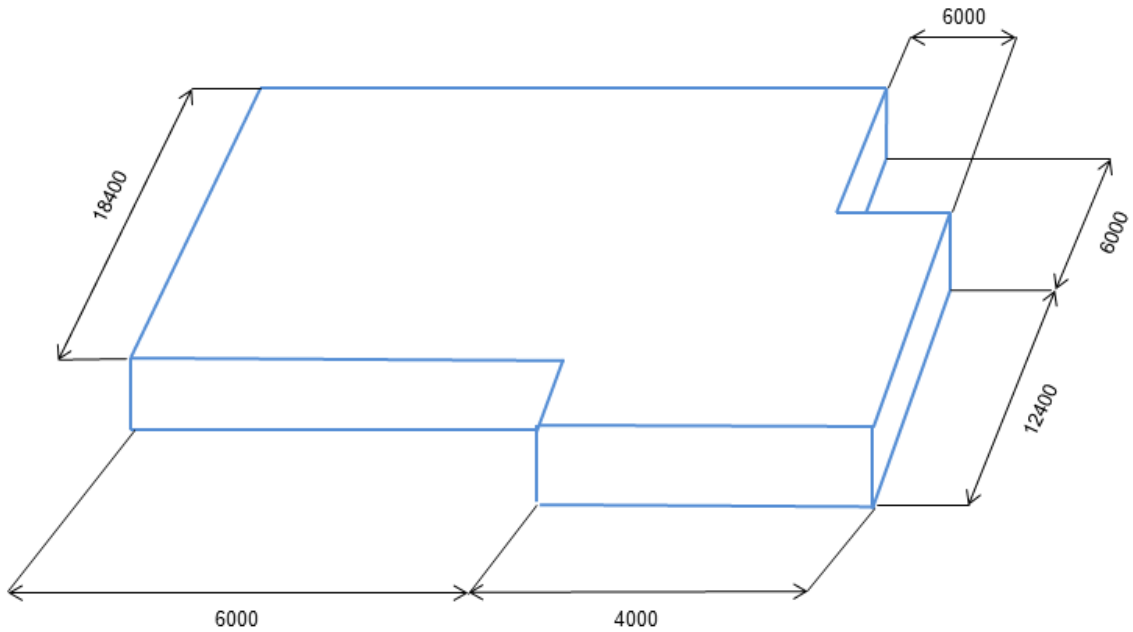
Volumen de la Cubierta superior de la cámara de máquinas (cotas en mm) (Plano 4)
